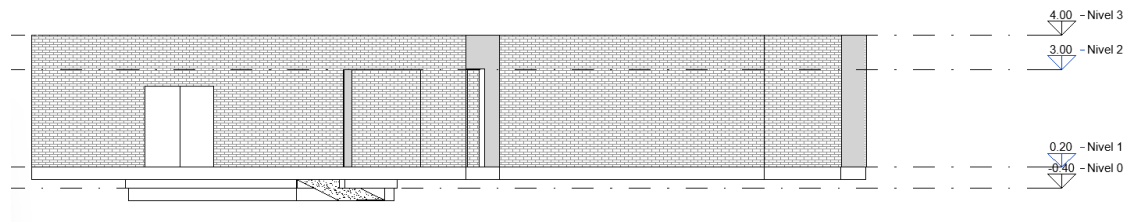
Alzado Oeste modelo levantamiento con iPhone. Fuente: elaboración propia.
